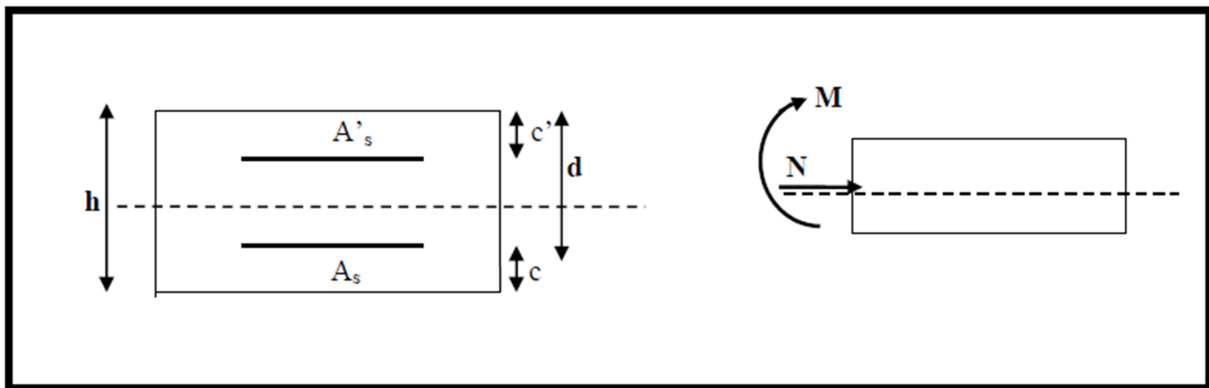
Schéma statique de la section de l'acrotère.
